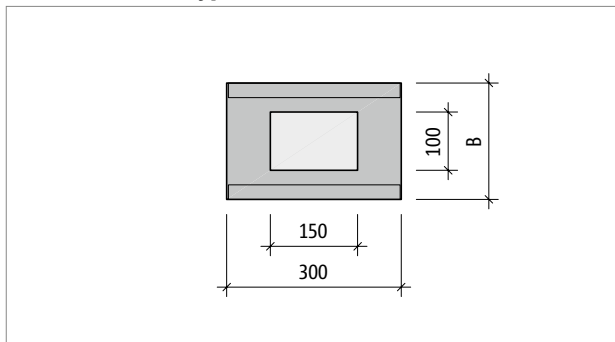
Schöck Sconnex® Typ W-N: Produktgrundriss; Drucklagerfläche 150 mm × 100 mm
